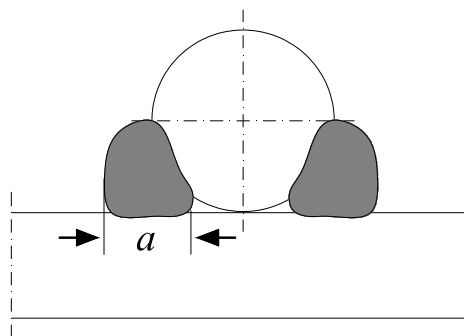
Espessura efetiva do cordão de soldadura aplicado no contorno de superfície arredondada (adaptado de NP EN 1993-1-8, 2010)
